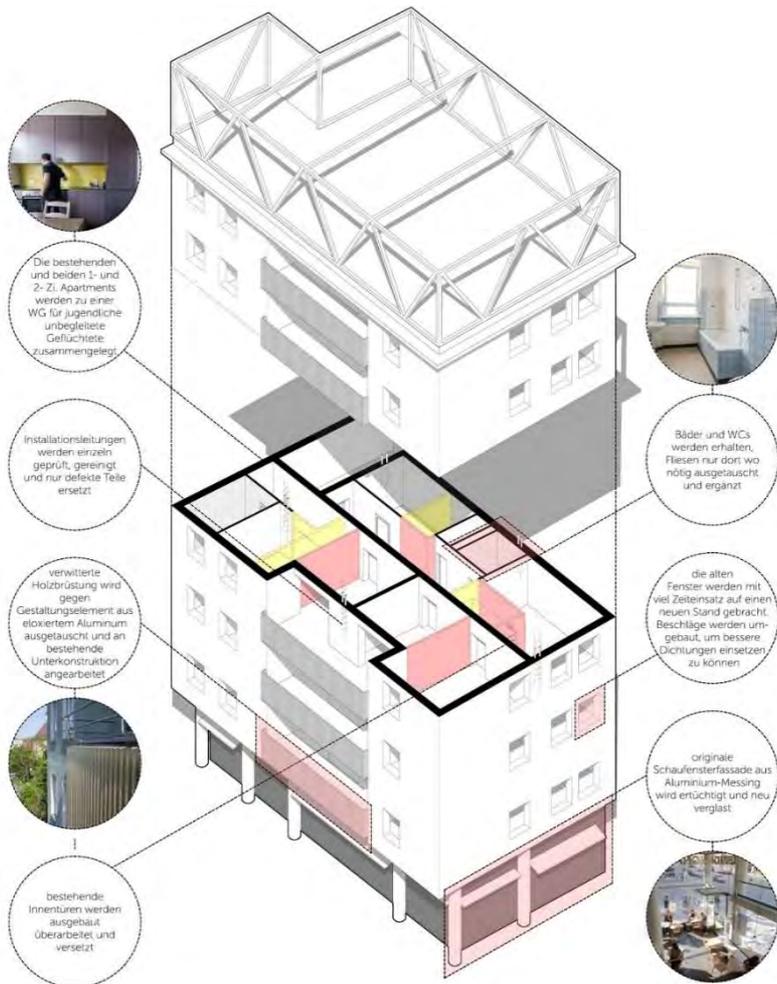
Bellevue di Monaco, München, hirner & riehl architekten, 2013-17, 3D Schnitt durch das Bauwerk
